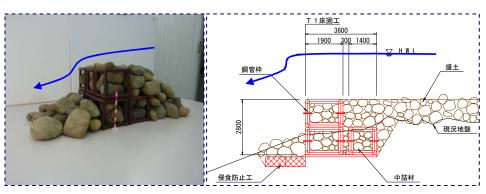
鋼管枠工施工イメージ(左:模型)と T1 設計断面図(右)
